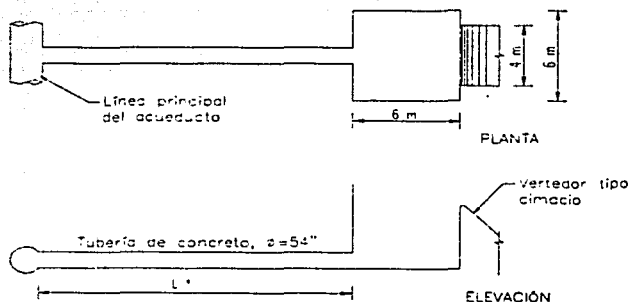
Planta del Quebracargas – I, km 64+876.70
